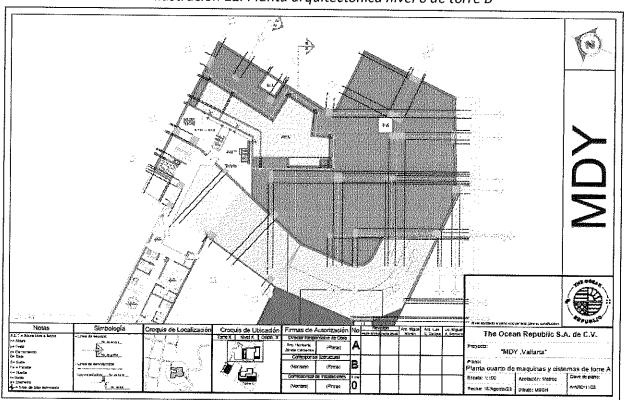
Planta cuarto de máquinas y cisternas de torre A
